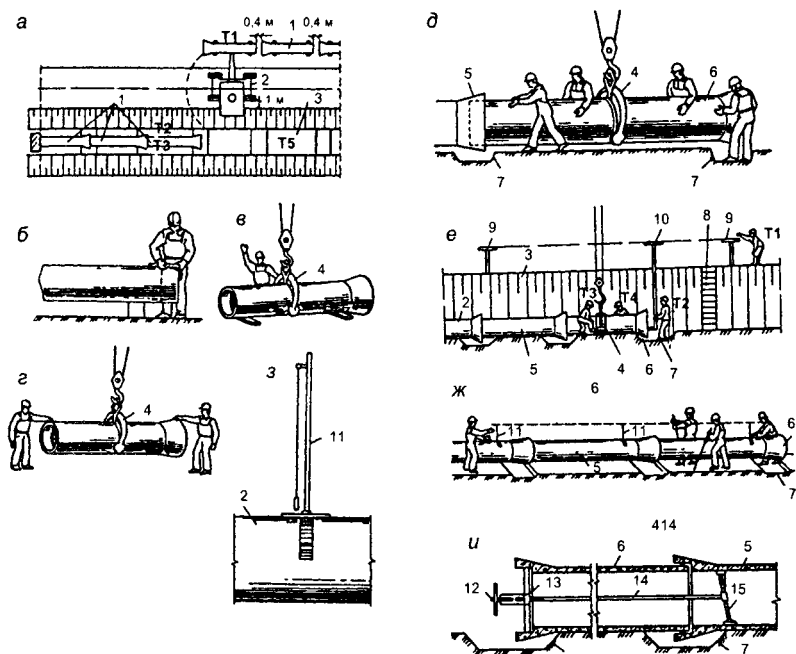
Основные рабочие операции при монтаже трубопровода из железобетонных раструбных труб:
